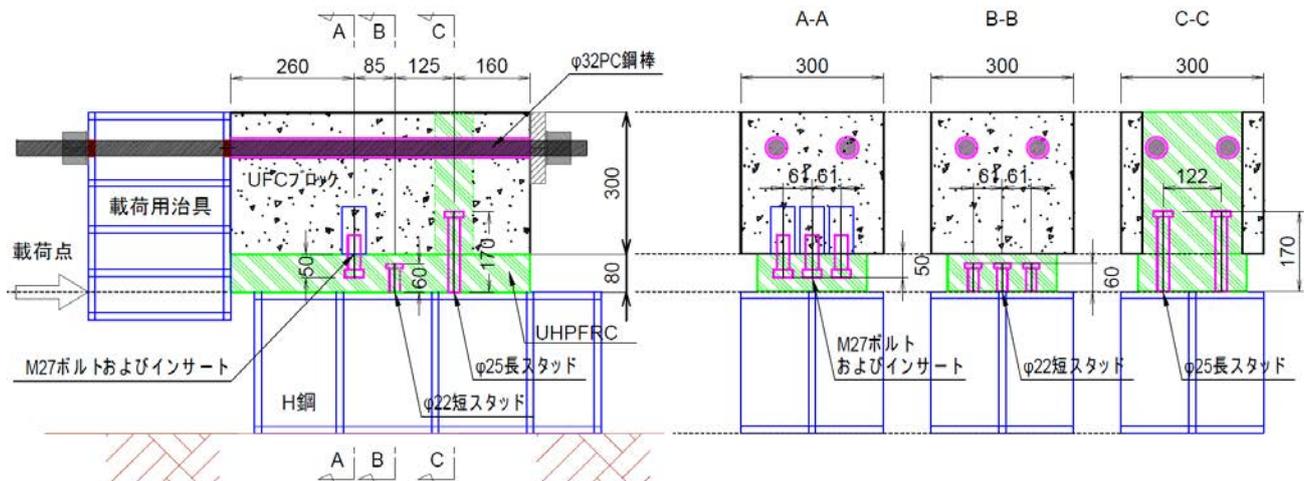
一面せん断試験体の形状（左側：正面図，右側：断面図）
